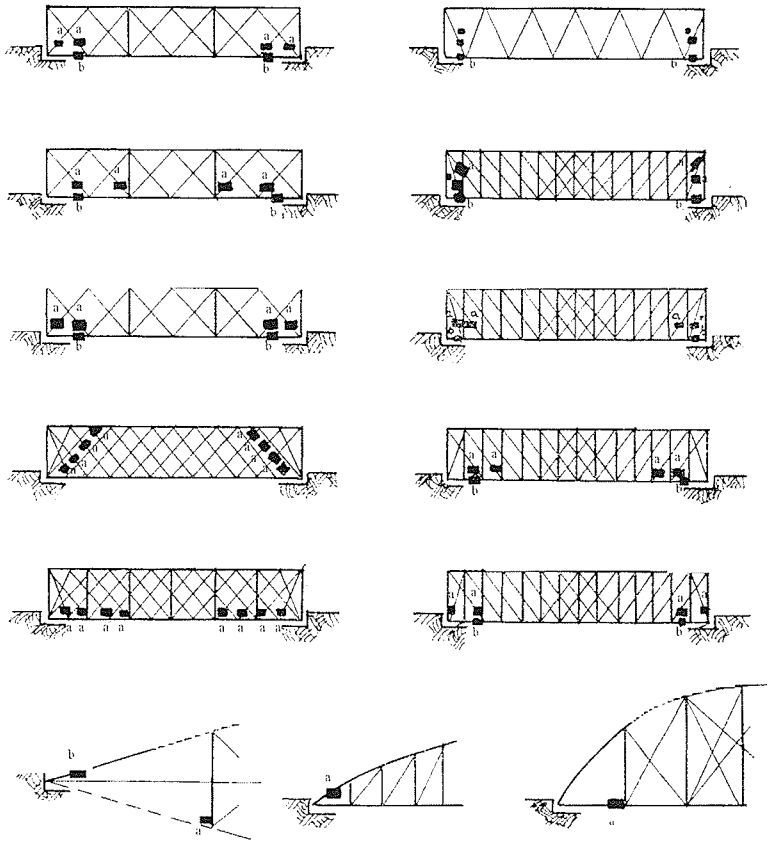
Diversos tipos de vigas metálicas, con las cargas colocadas para su destrucción
